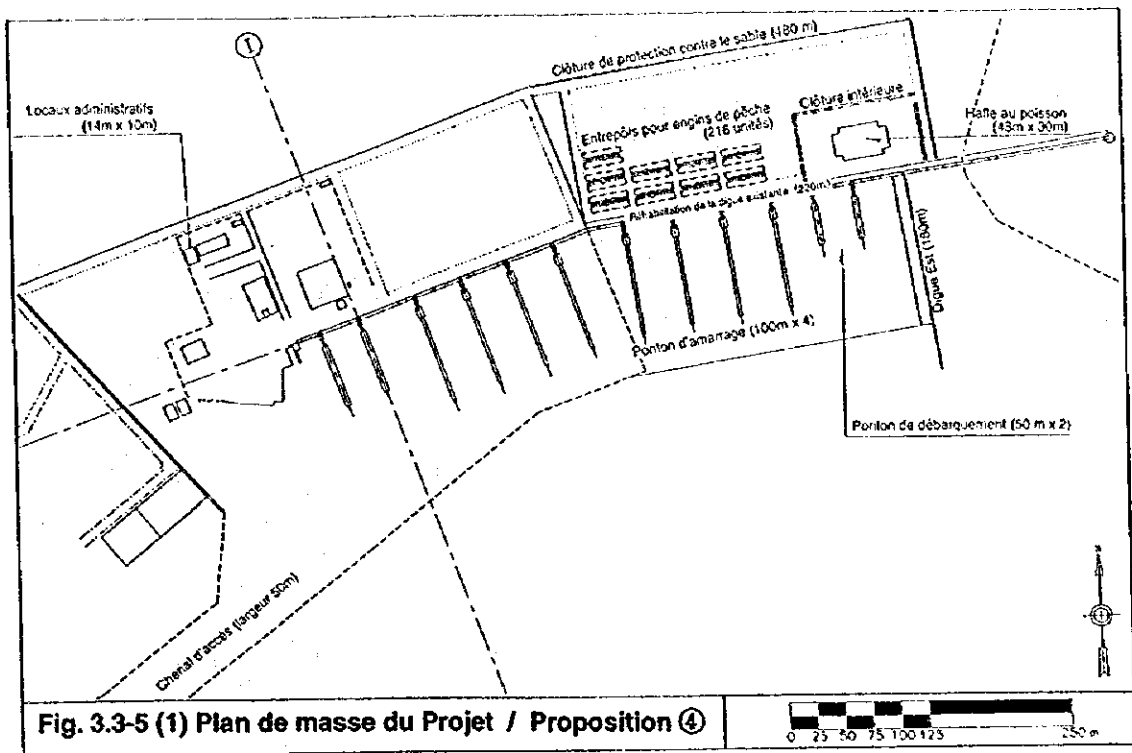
(1) Plan de masse du Projet / Proposition ④
